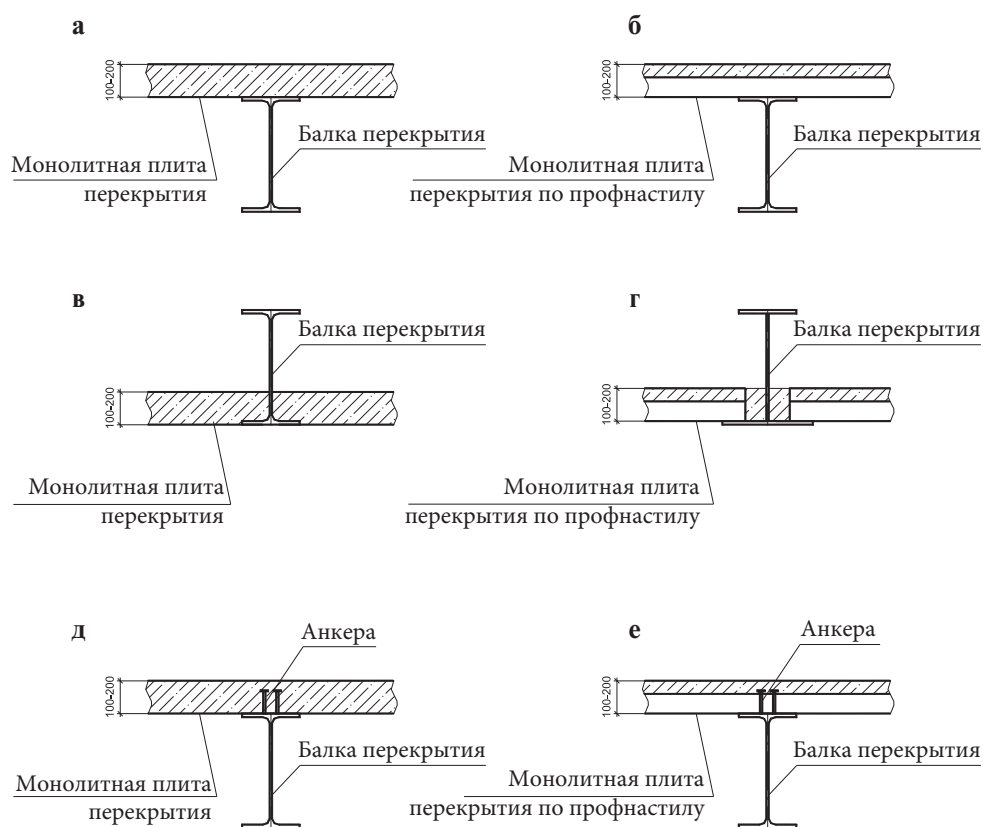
Перекрытия многоэтажных зданий со стальным каркасом с монолитными железобетонными плитами с опиранием: а) на верхнюю полку балки по съемной опалубке без устройства связей, воспринимающих сдвиг; б) то же по несъемной опалубке из профилированного настила; в) на нижнюю полку по съемной опалубке; г) то же по несъемной опалубке из профилированного настила; д) на верхнюю полку балки с устройством противосдвиговых связей и образованием композитной сталежелезобетонной конструкции по съемной опалубке; е) то же по несъемной опалубке из профилированного настила
